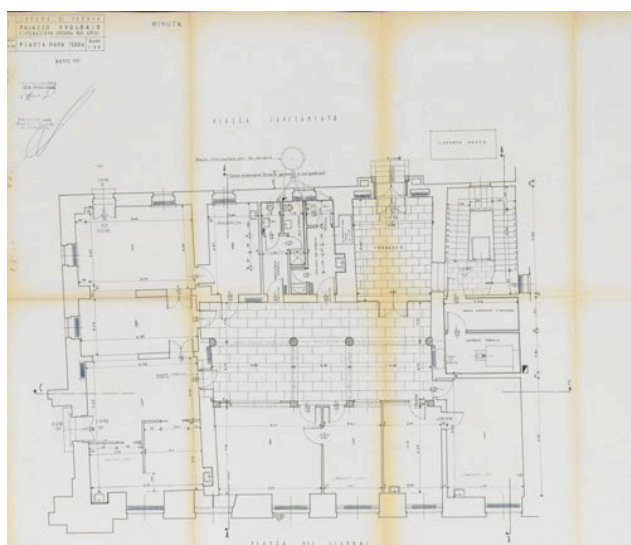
Estratto pianta piano terra (1960) - (Archivio del Comune di Padova)
